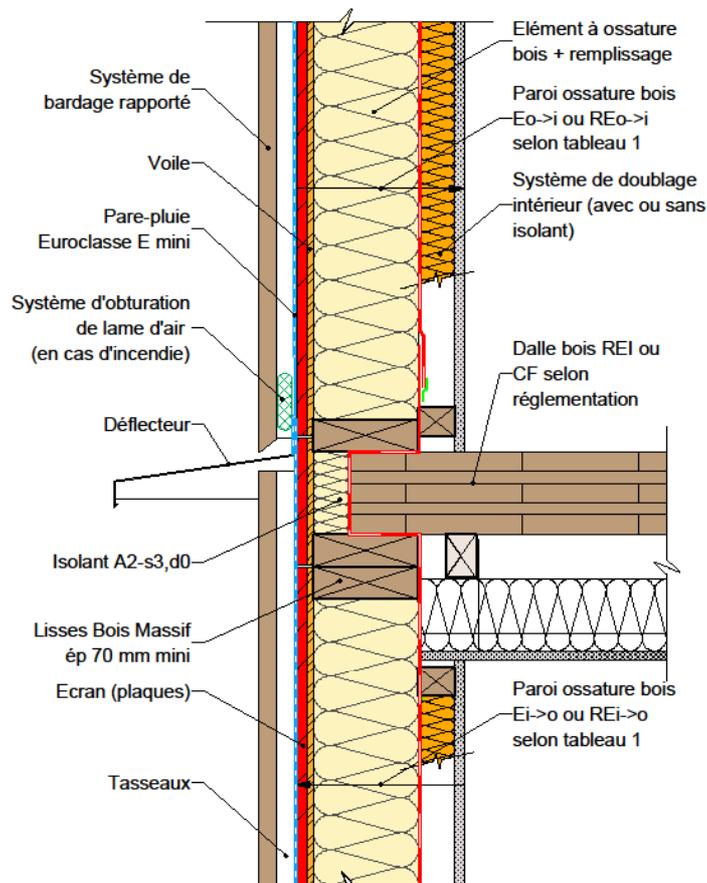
Façade/mur en ossature bois & plancher en panneau bois massif.
